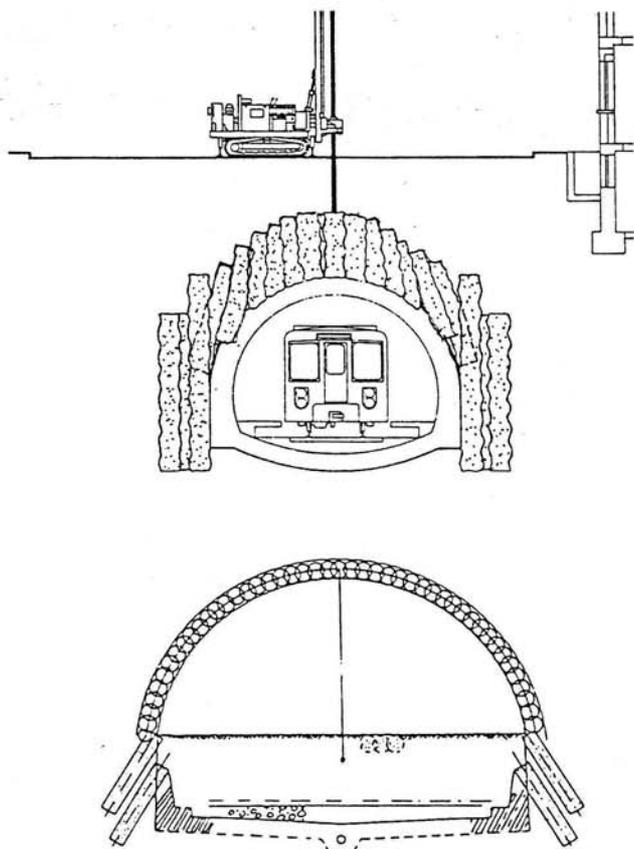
Deux exemples, parmi tant d'autres, d'utilisation de consolidation par Jet Grouting en tunnel.
